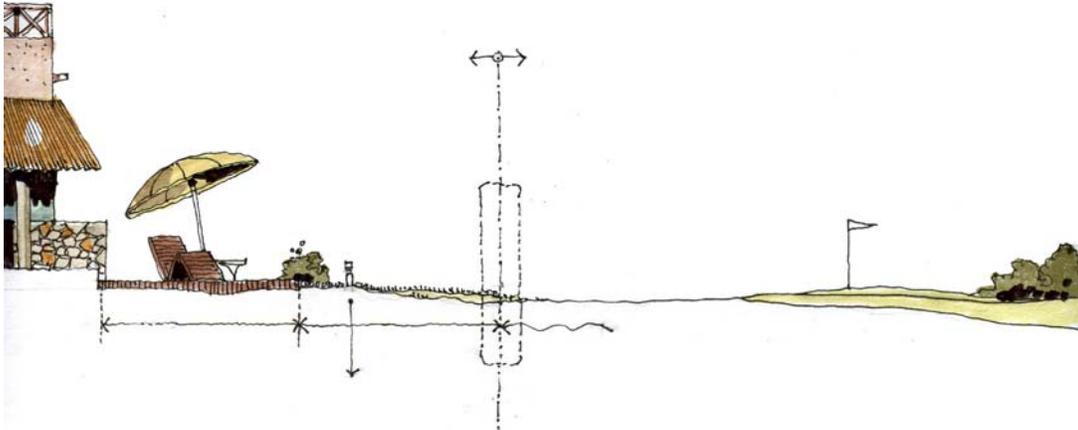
Ejemplo de construcción desplanta a mayor nivel de altura natural.
